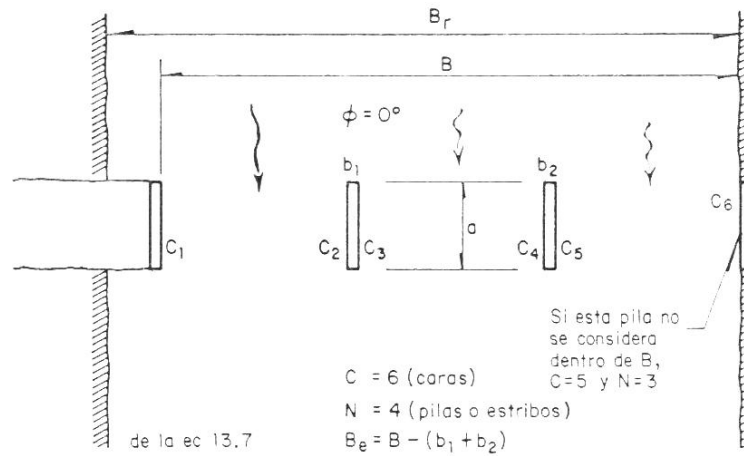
Ancho efectivo B_e en puentes cuando las pilas están alineadas con el flujo.
